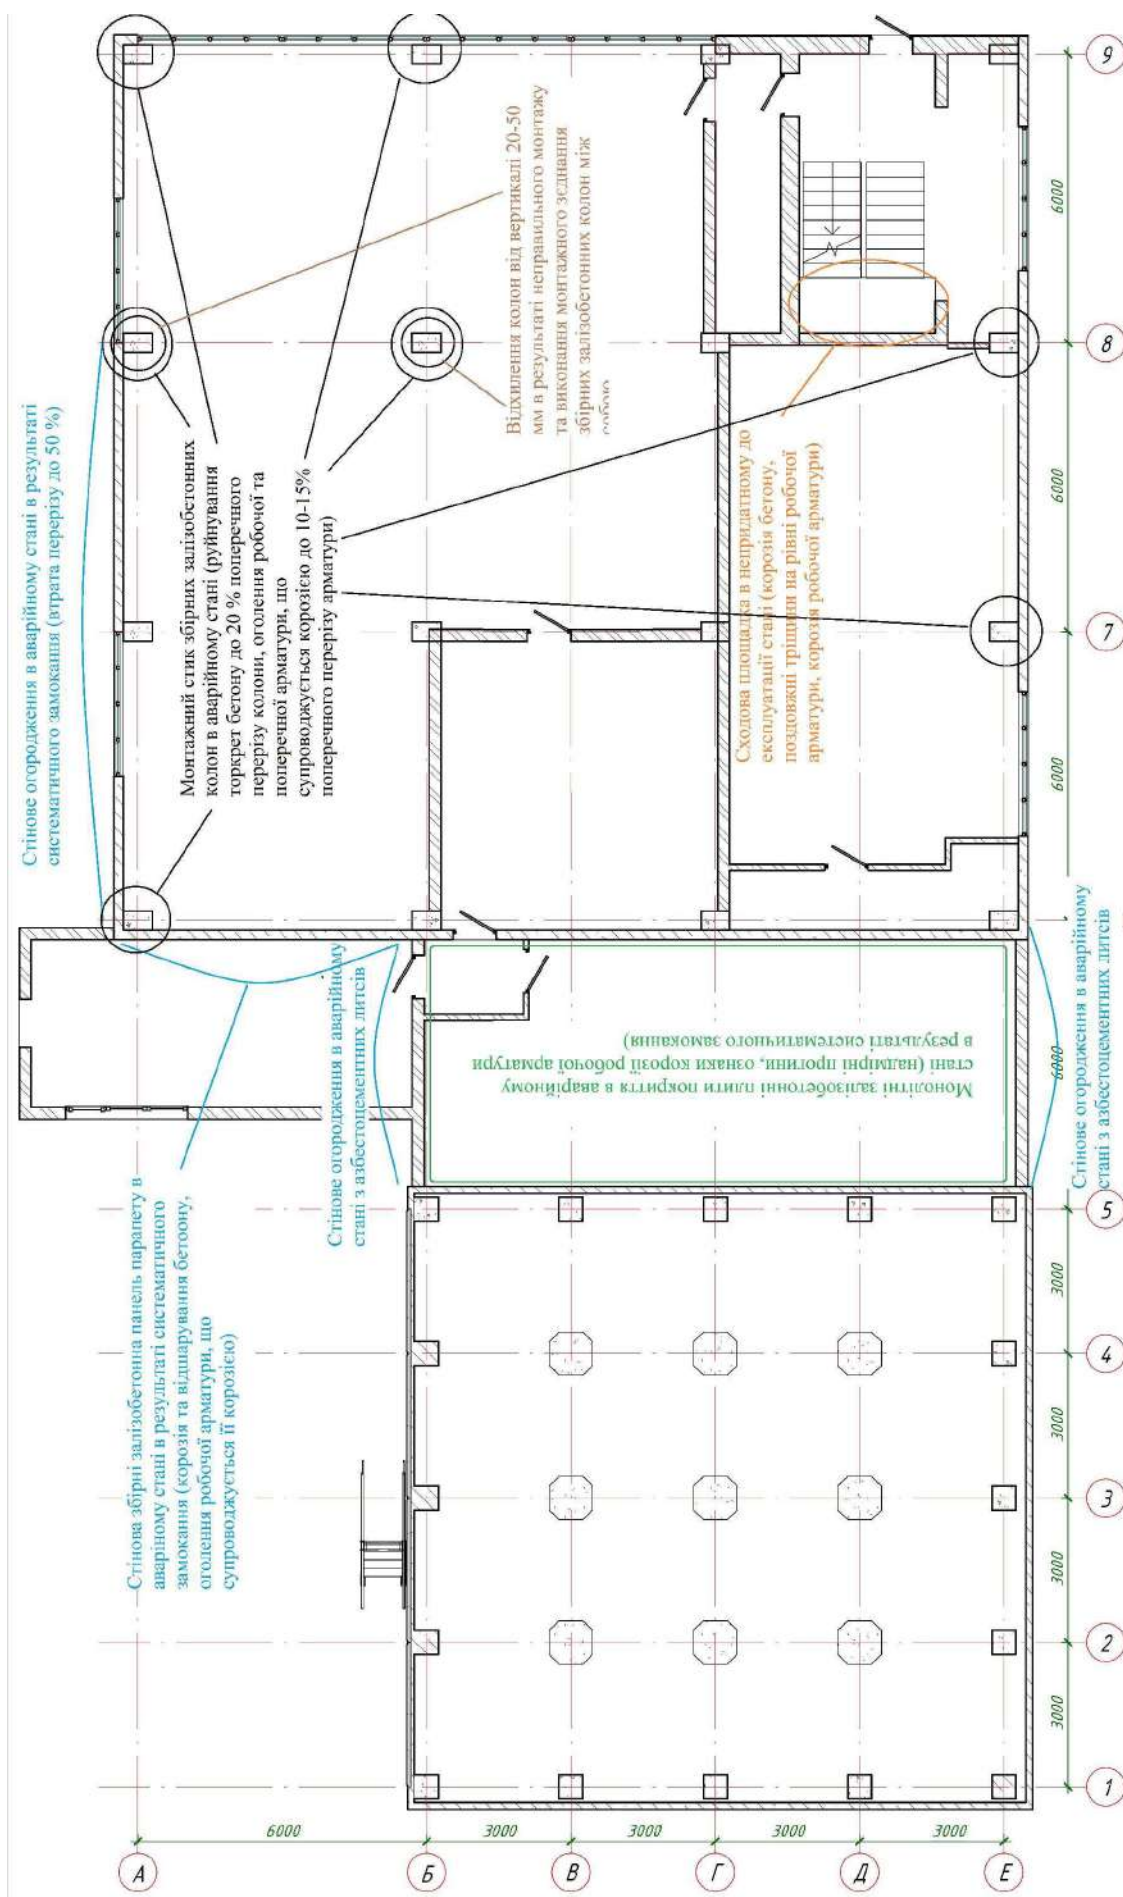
Схема виявлених дефектів, що впливають на подальшу надійну та безпечну експлуатації будівлі Круп'яного цеху під літ. «К» на плані 4-го поверху
